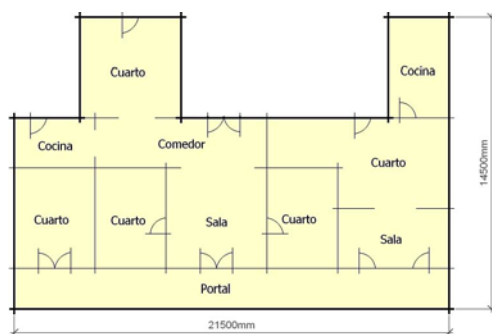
Ejemplo de planta rectangular paralela la calle y medianera
